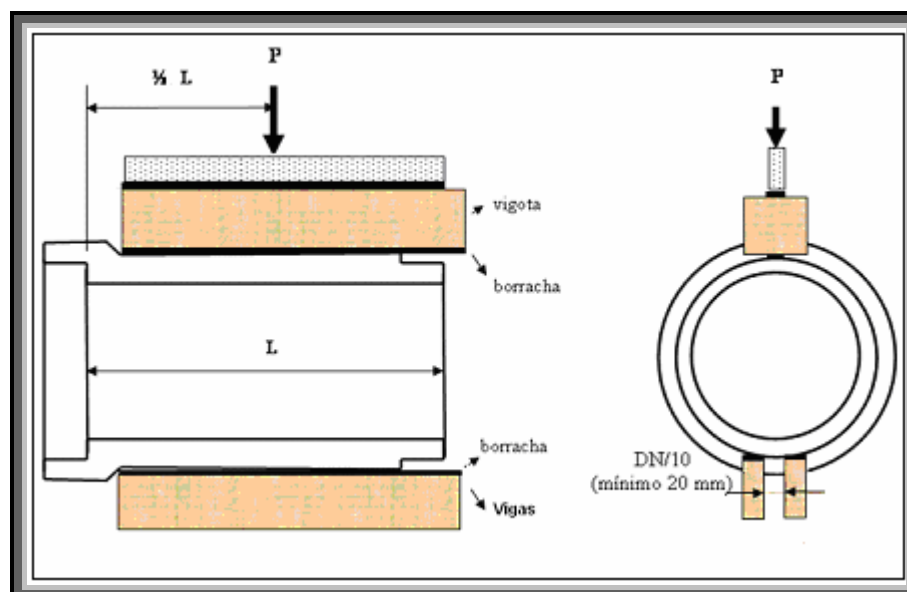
Esquema do ensaio de compressão diametral para tubos de concreto do tipo ponta e bolsa
